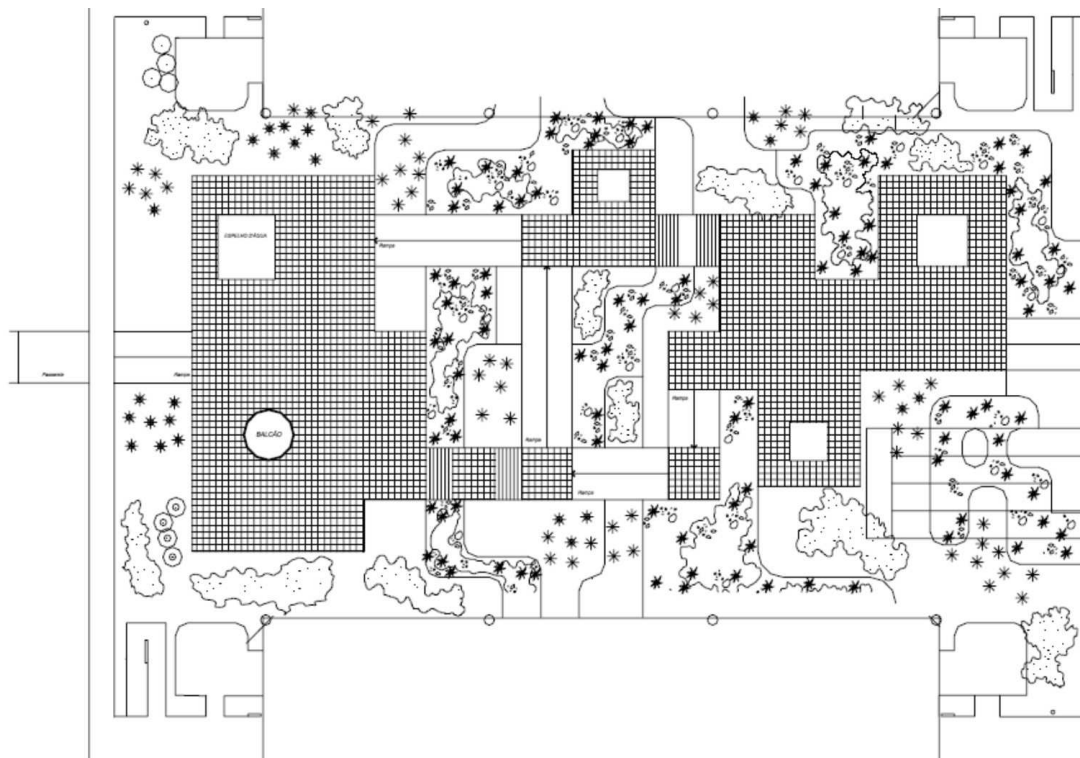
Planta Praça Central Centro Administrativo do BNB
